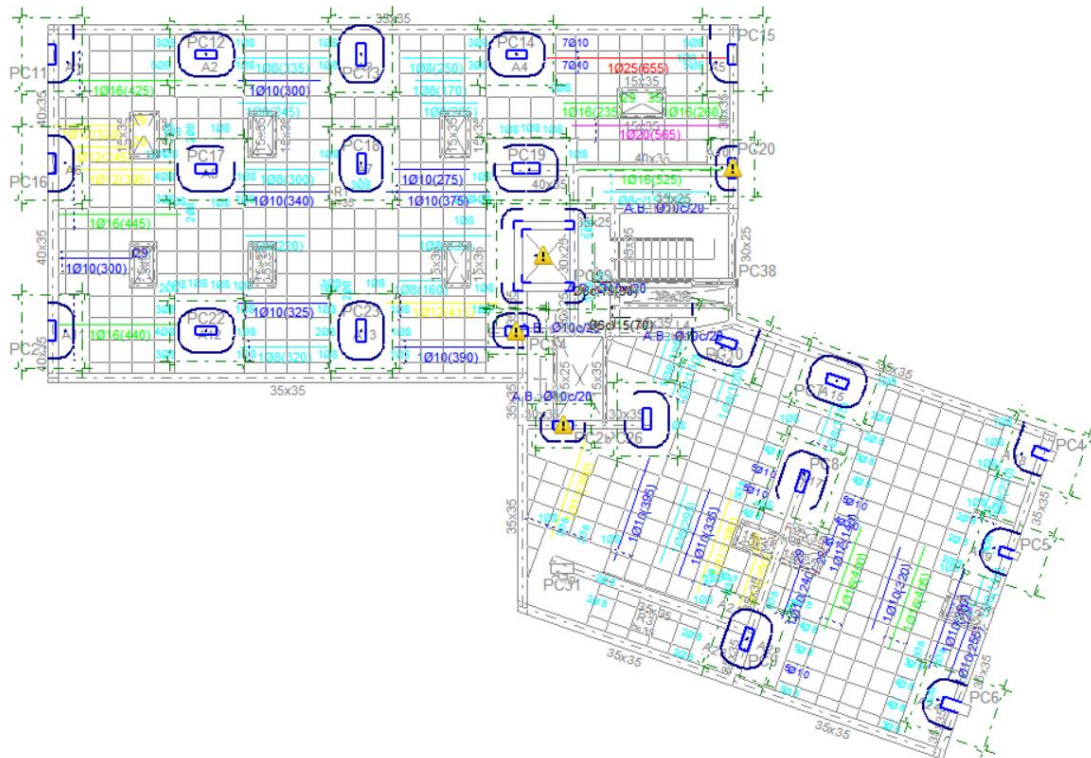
Punzonamiento Planta Cubierta, Módulo C
